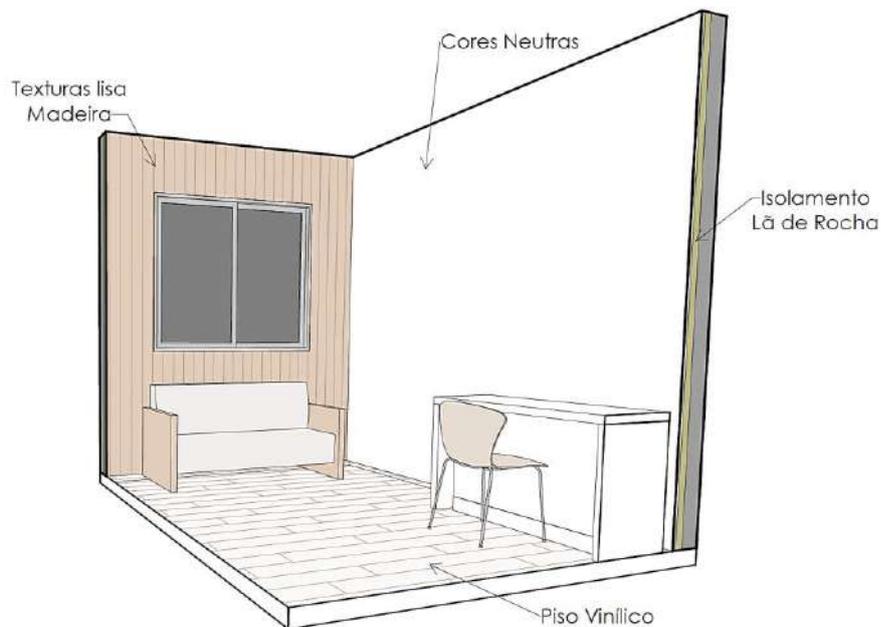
Espaço de Fuga - Detalhamento em Planta Baixa
